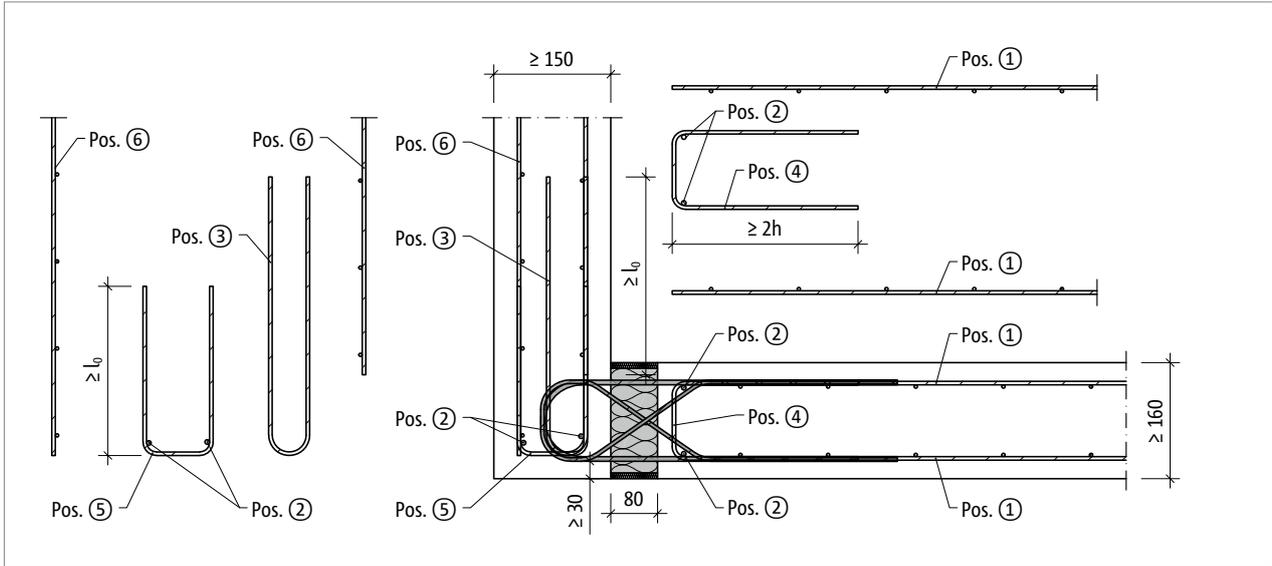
Schöck Isokorb® T Typ AP horizontale Anordnung: Bauseitige Bewehrung
